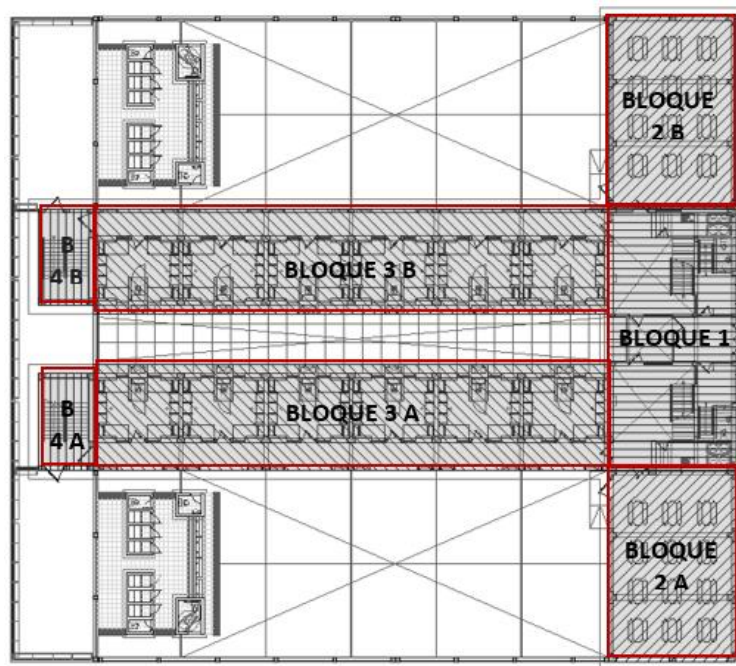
Diseño estructural del pabellón de internamiento
